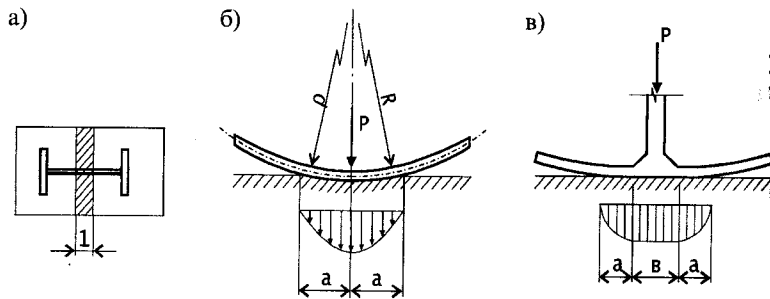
Модель, учитывающая совместную работу опорной плиты и бетона фундамента
